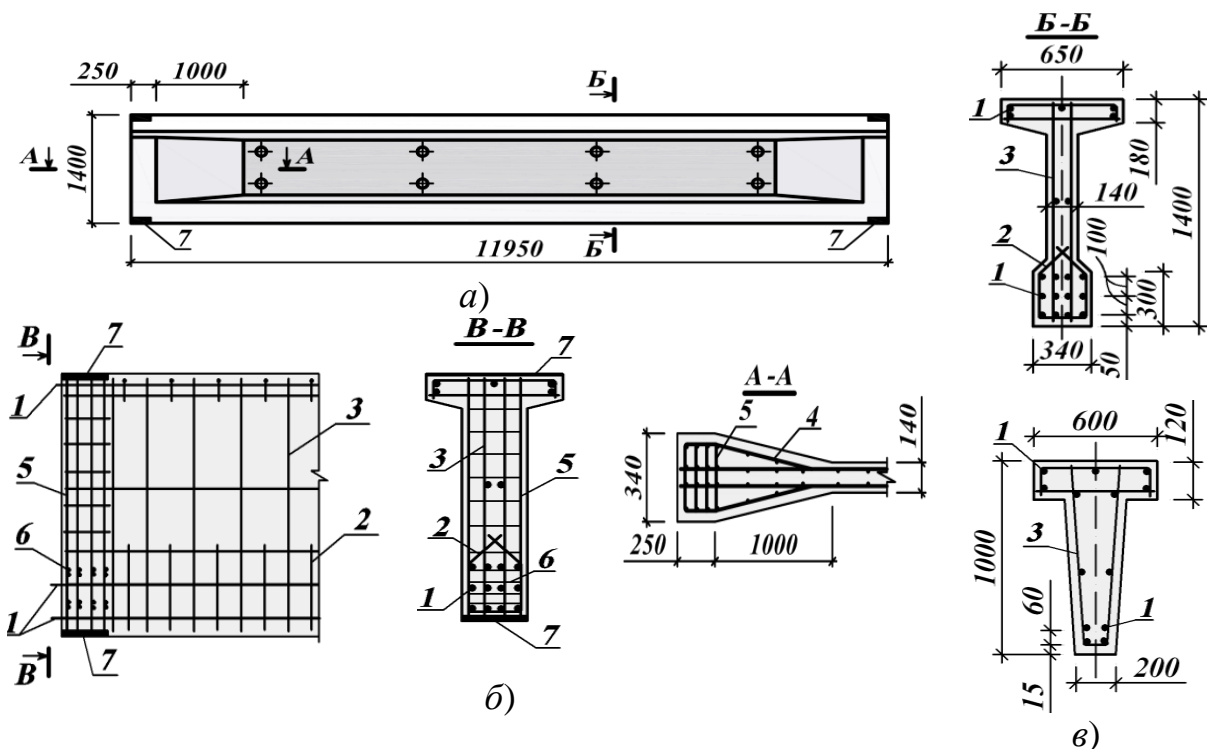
Залізобетонні збірні попередньо напружені підкранові балки:
